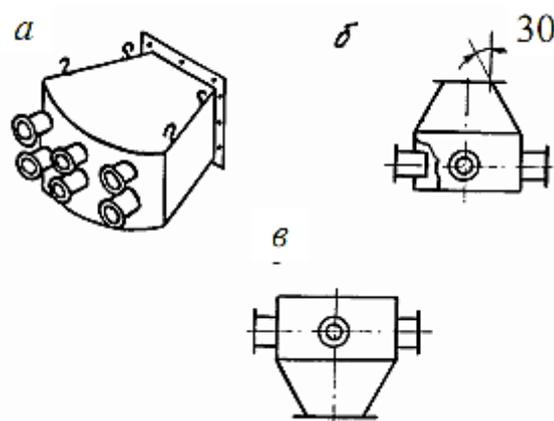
Коллекторы: а - горизонтальный типа КГ; б - вертикальный типа КВВ; в - вертикальный типа КВН
